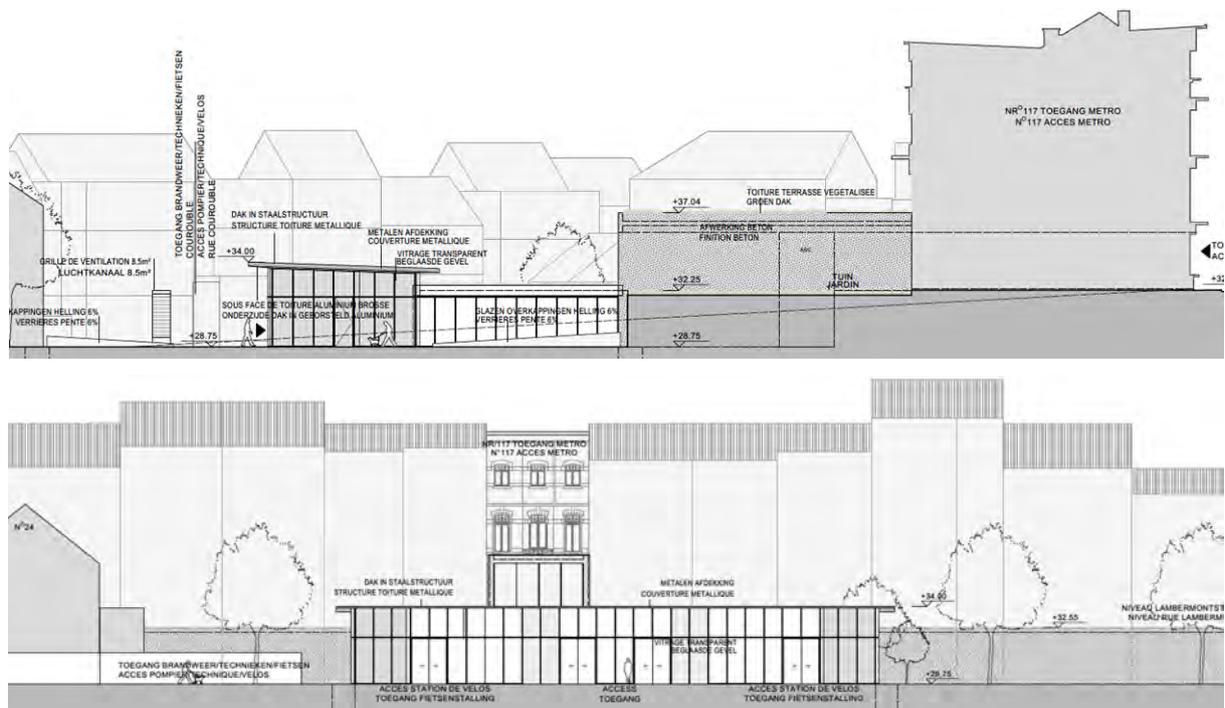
Élévations sud-est (en haut) et sud-ouest (en bas) du pavillon nord en intérieur d'îlot (BMN, 2018)
